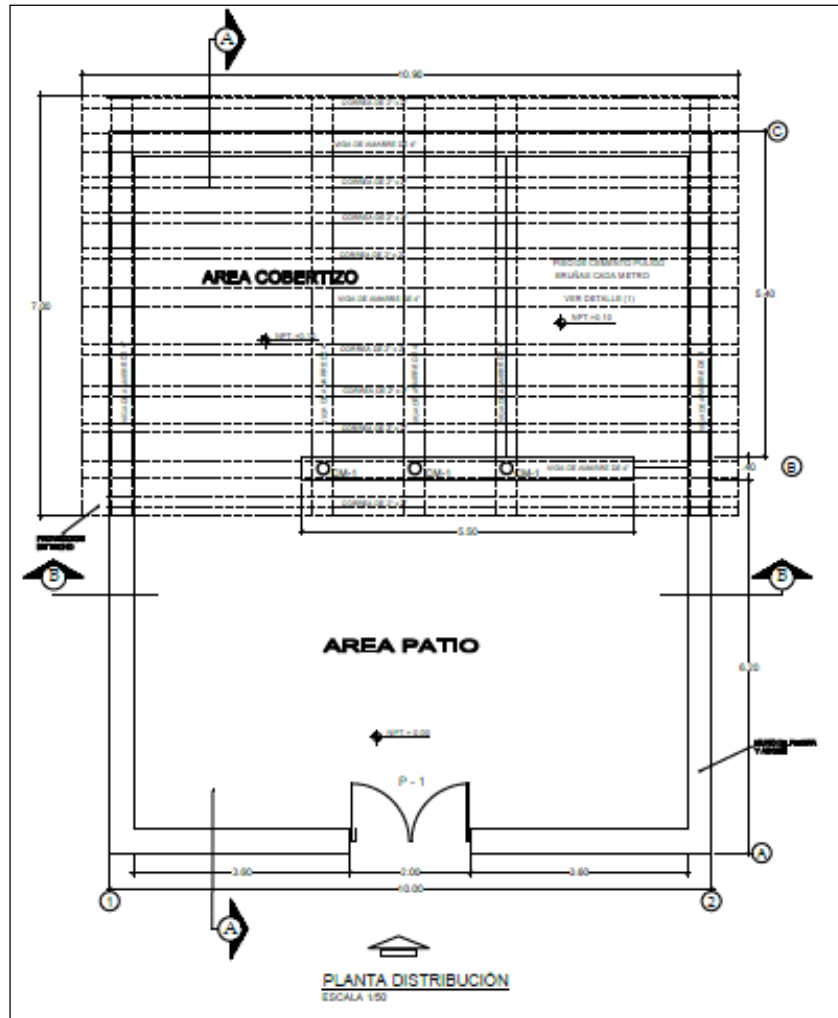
Plano en Planta Cobertizo - Diseño 01, Arequipa
